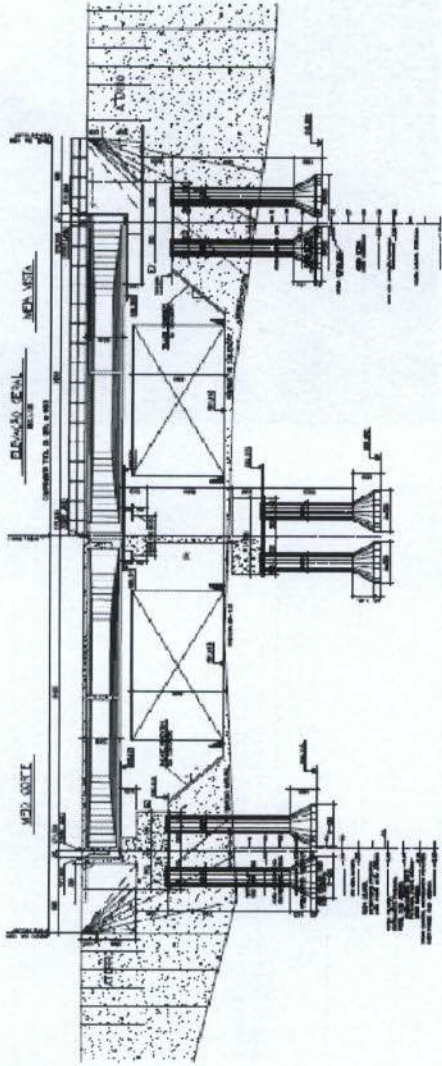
Projeto do viaduto sobre a BR 135 (elevação em corte)
